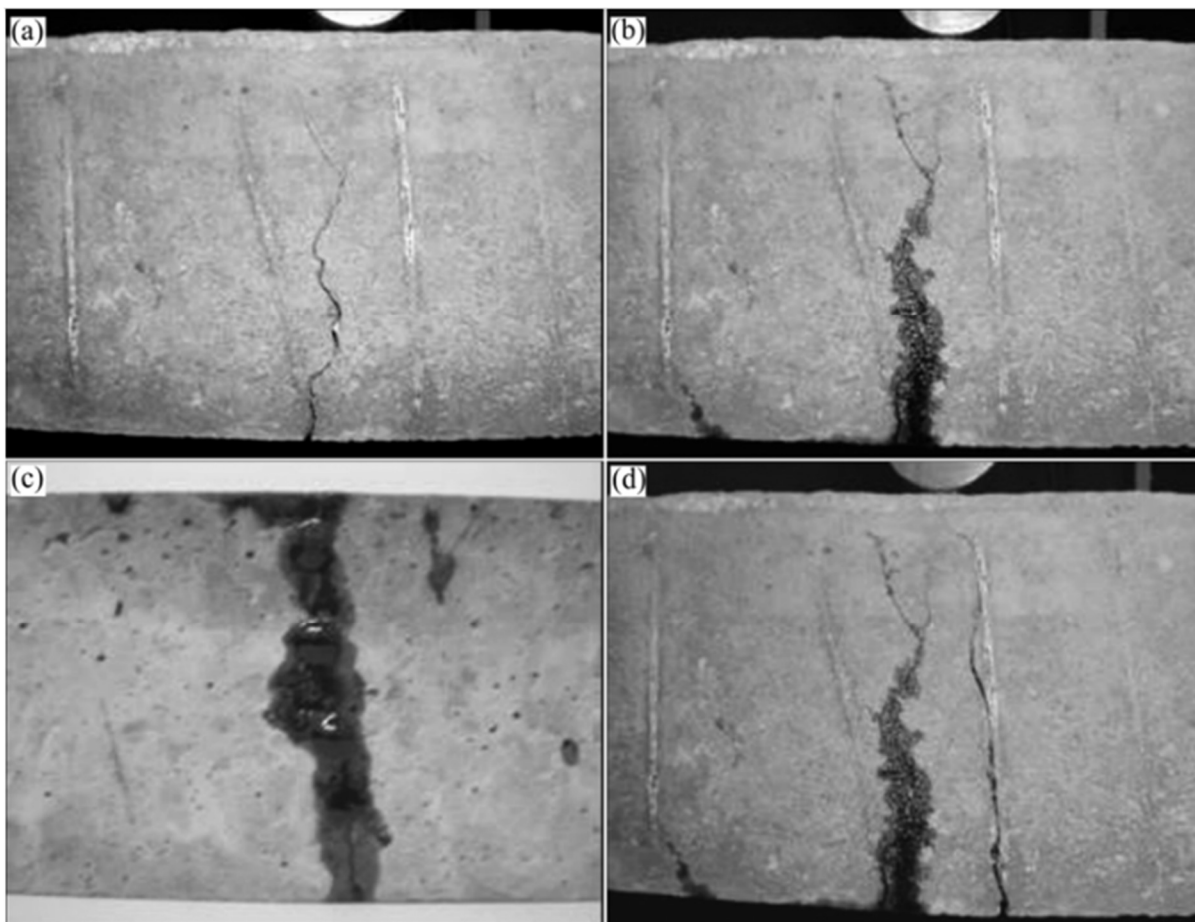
a) fissura aparece próxima ao centro da viga. b) Agente cicatrizante flui até o exterior e preenche a fissura. c) Fissura reparada. d) A fissura não se abre, porém, outra fissura se forma nas proximidades (Adaptado de Kuang e Ou, 2008).
